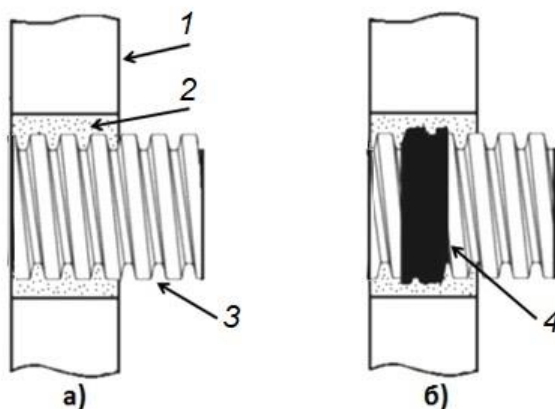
Ввод трубы типа «ССД-Пайп» 125 мм в стену железобетонного колодца: 1 – наружная поверхность стены колодца; 2 – отверстие в стене колодца заполненное строительным (цементно-песчаным) раствором; 3 – выход трубы внутри колодца для надевания наружной заглушки; 4 – труба ССД-Пайп; 5 – кольцевой бандаж из ленточной мастики типов ЛМ или МГ 14-16.
